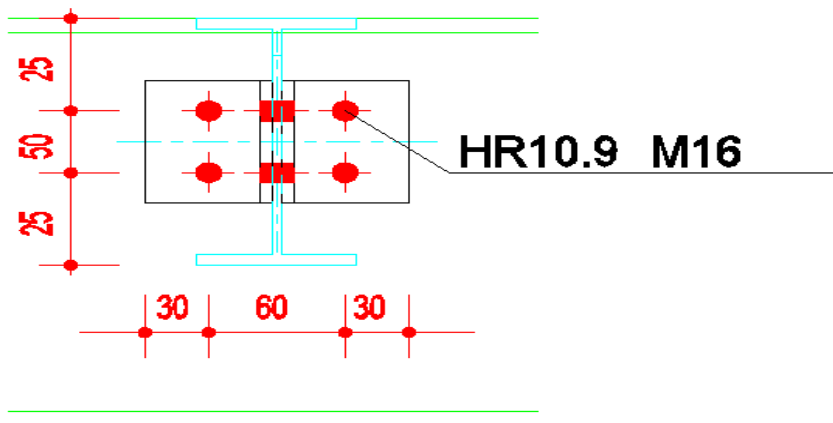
Assemblage poteau-console de la poutre de roulement.
